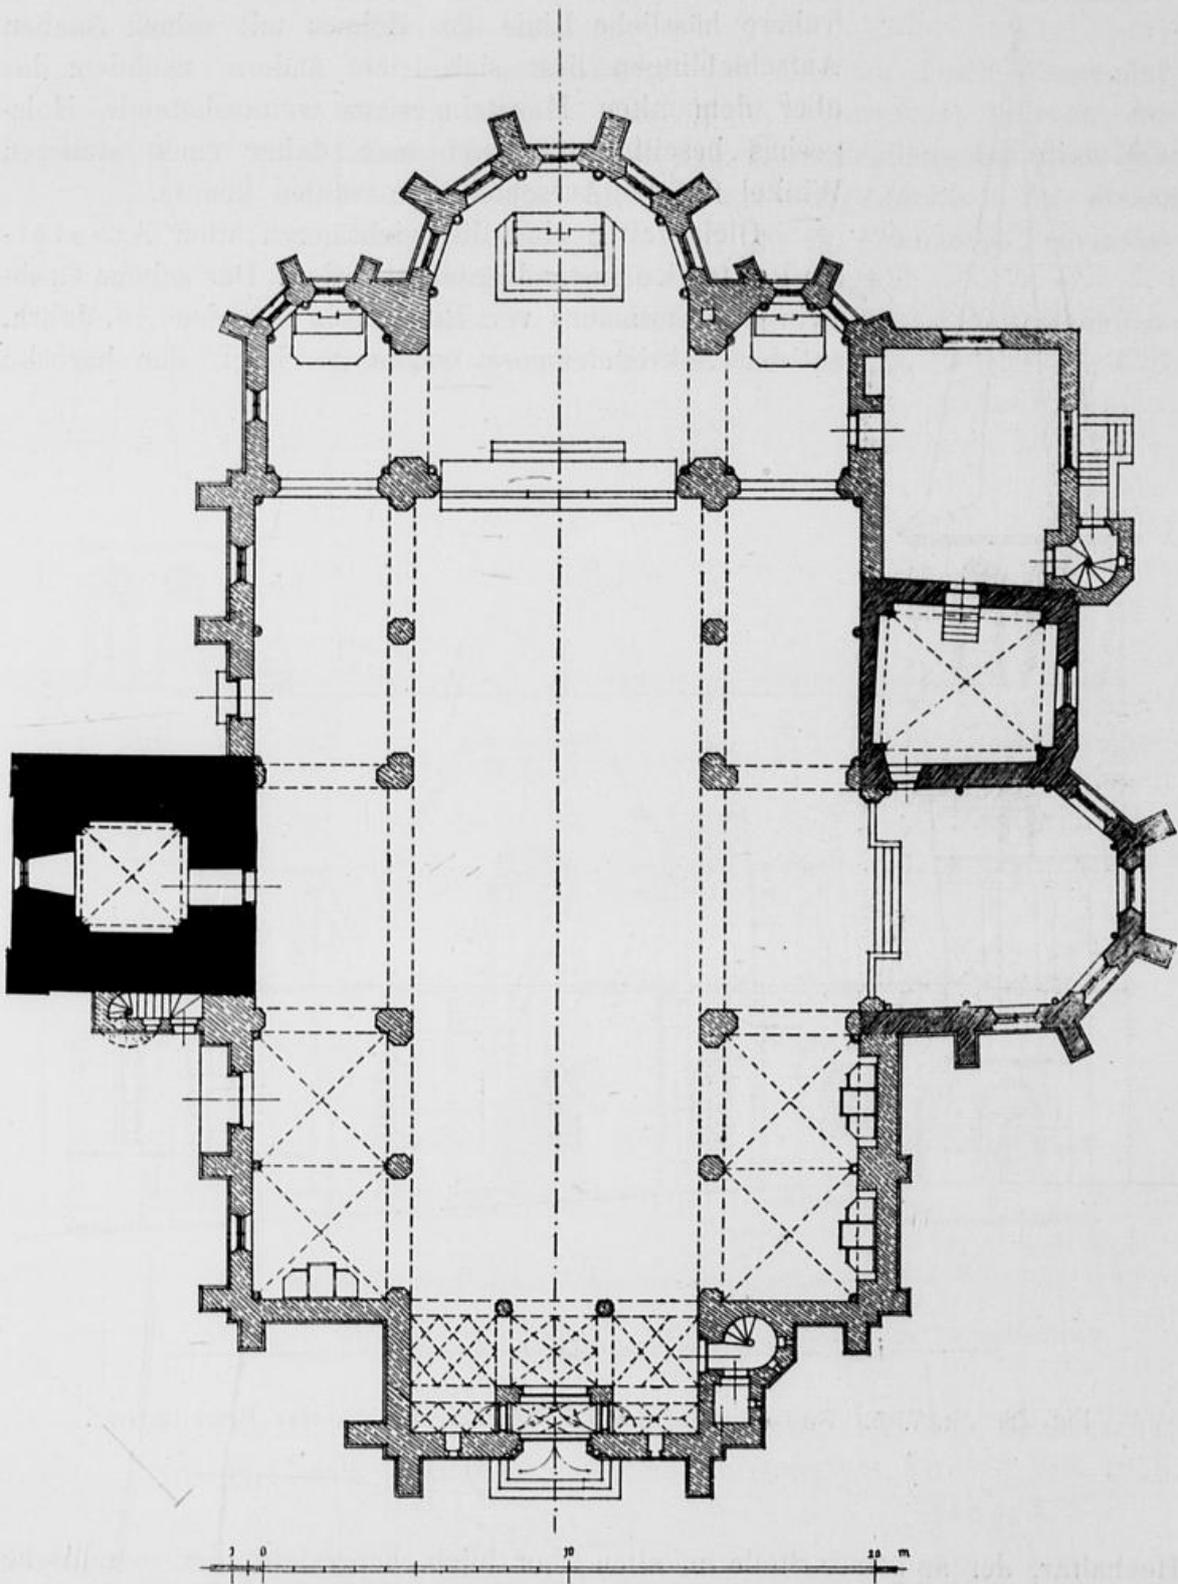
St. Vith. Grundriss der kath. Pfarrkirche nach der Erweiterung.
